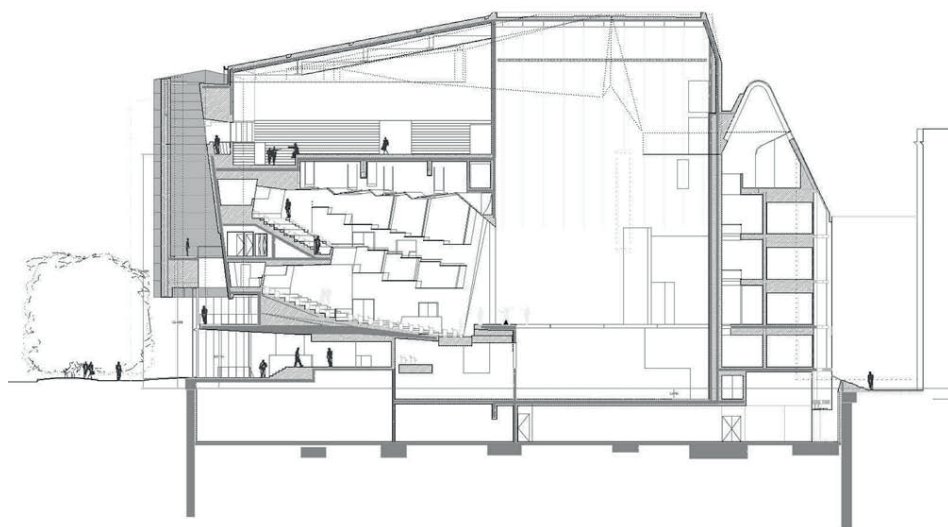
Sección transversal por Teatro Principal. *Informes de la Construcción*, nº 60
